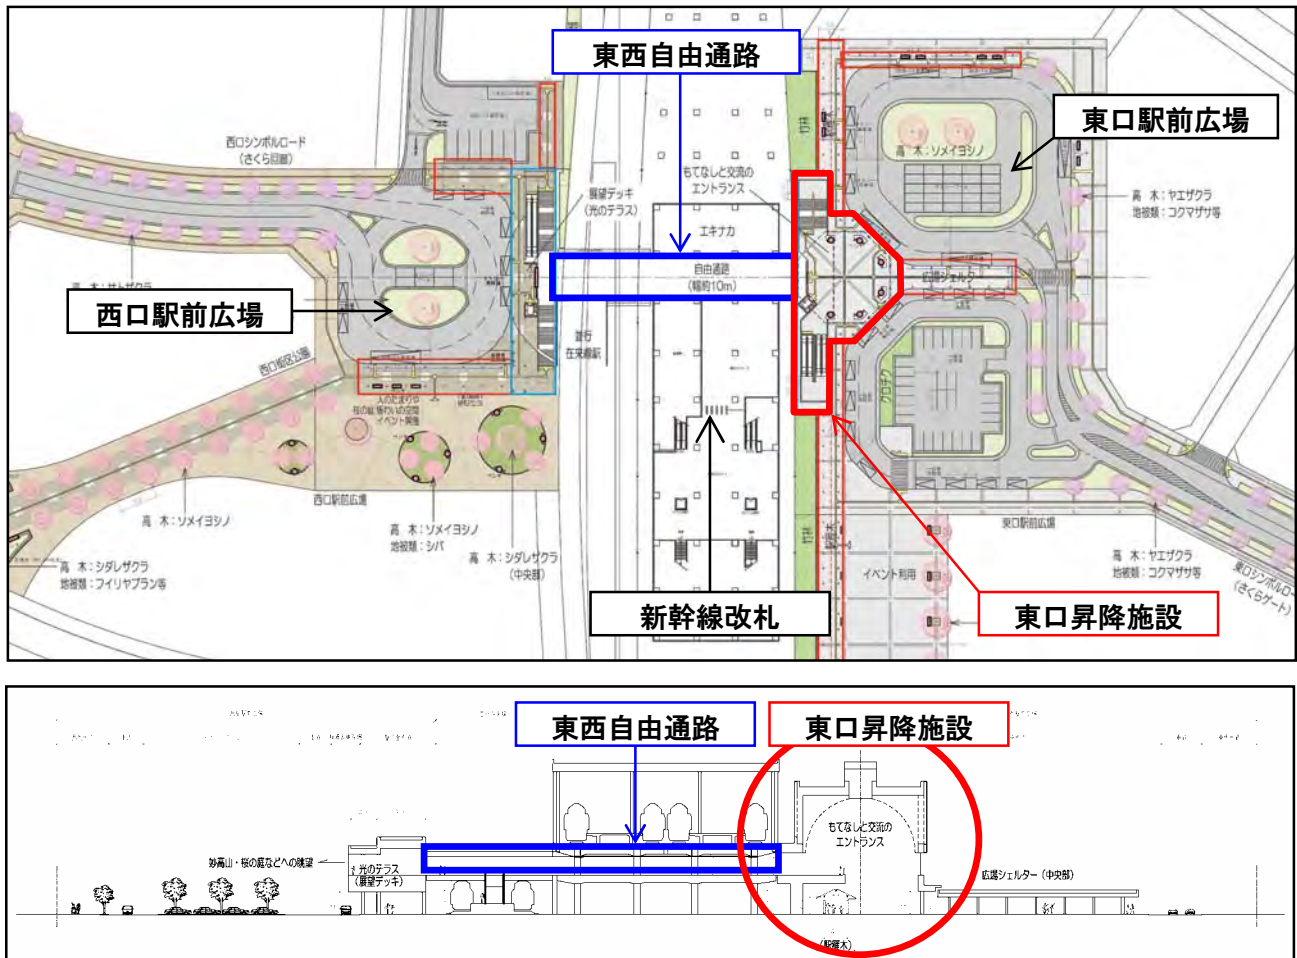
東口昇降施設の配置 (上: 平面図、下: 断面図)
